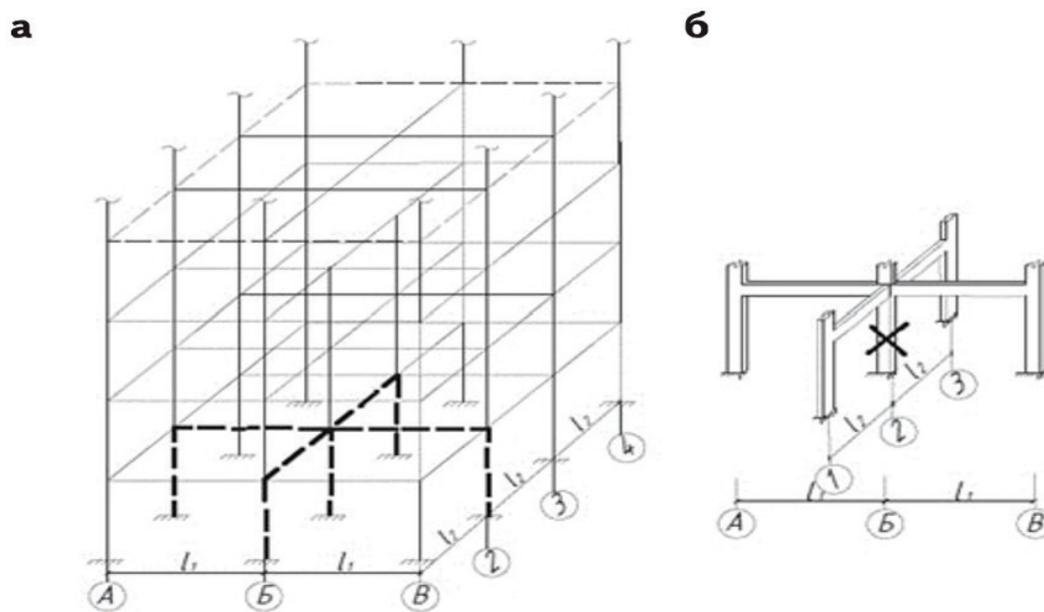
Схема железобетонного каркаса многоэтажного здания (а) и фрагмента в окрестности выключенной колонны А-2 (б)
